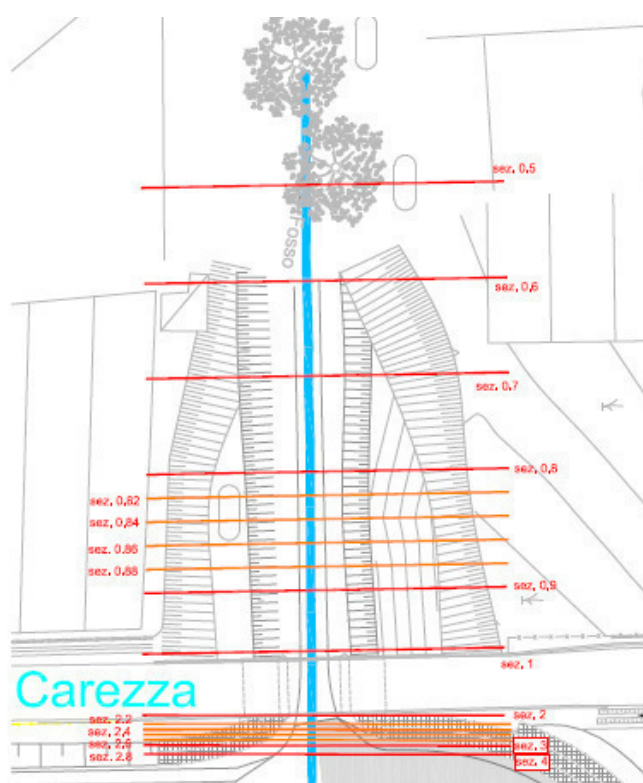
Disposizione planimetrica delle sezioni di calcolo
